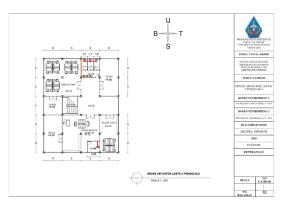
Denah Air Bersih Lantai 2 Pengelola
